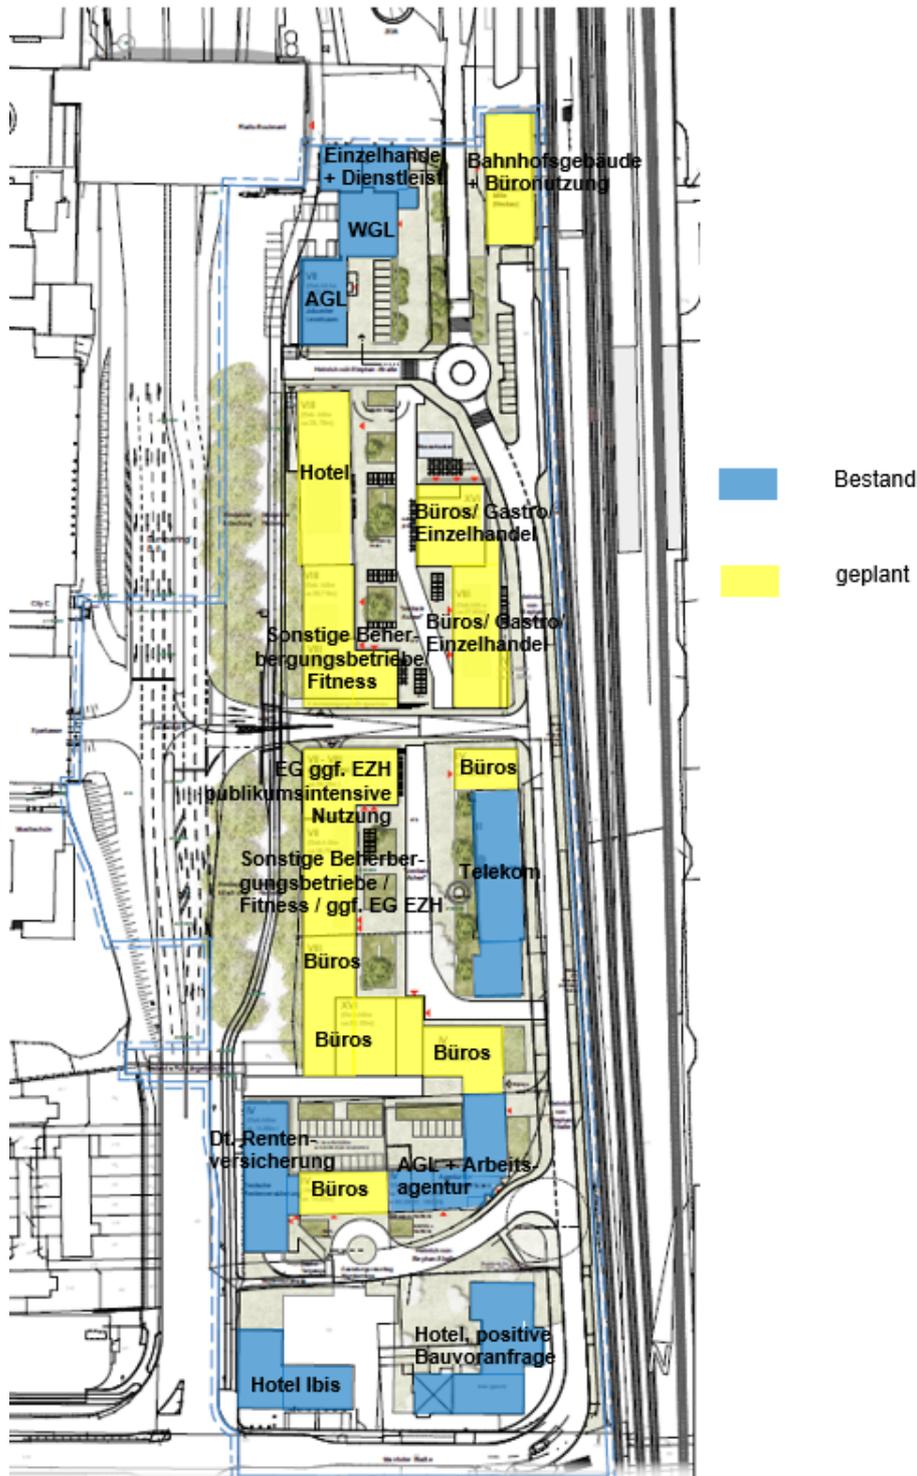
Städtebaulicher Rahmenplan [13] mit dem Bestand und der geplanten Nutzung
